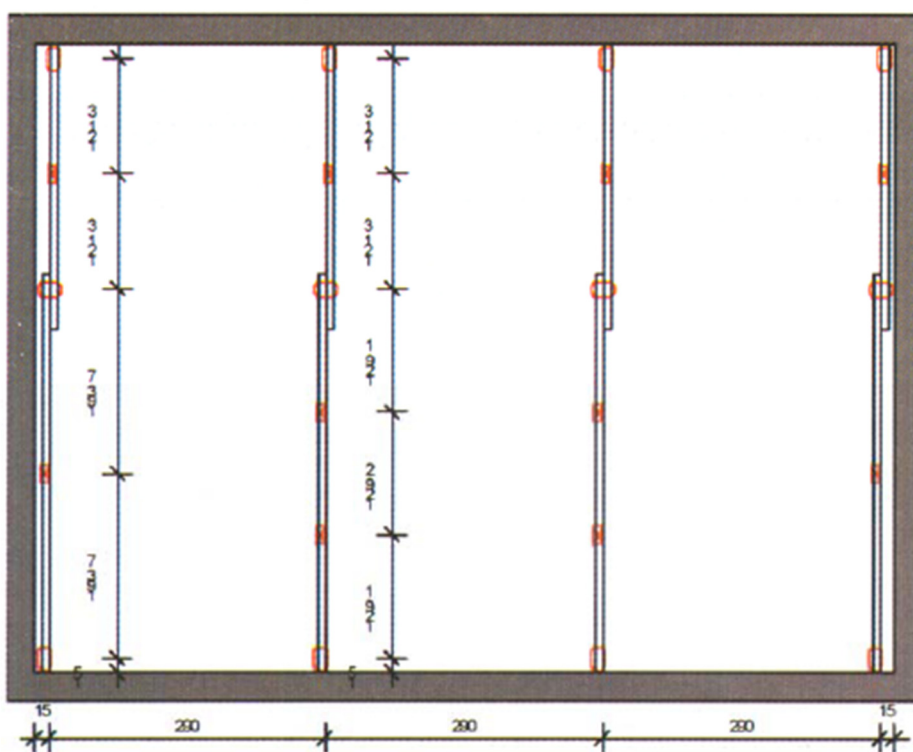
Вариант раскладки опалубки вдоль короткой стены
